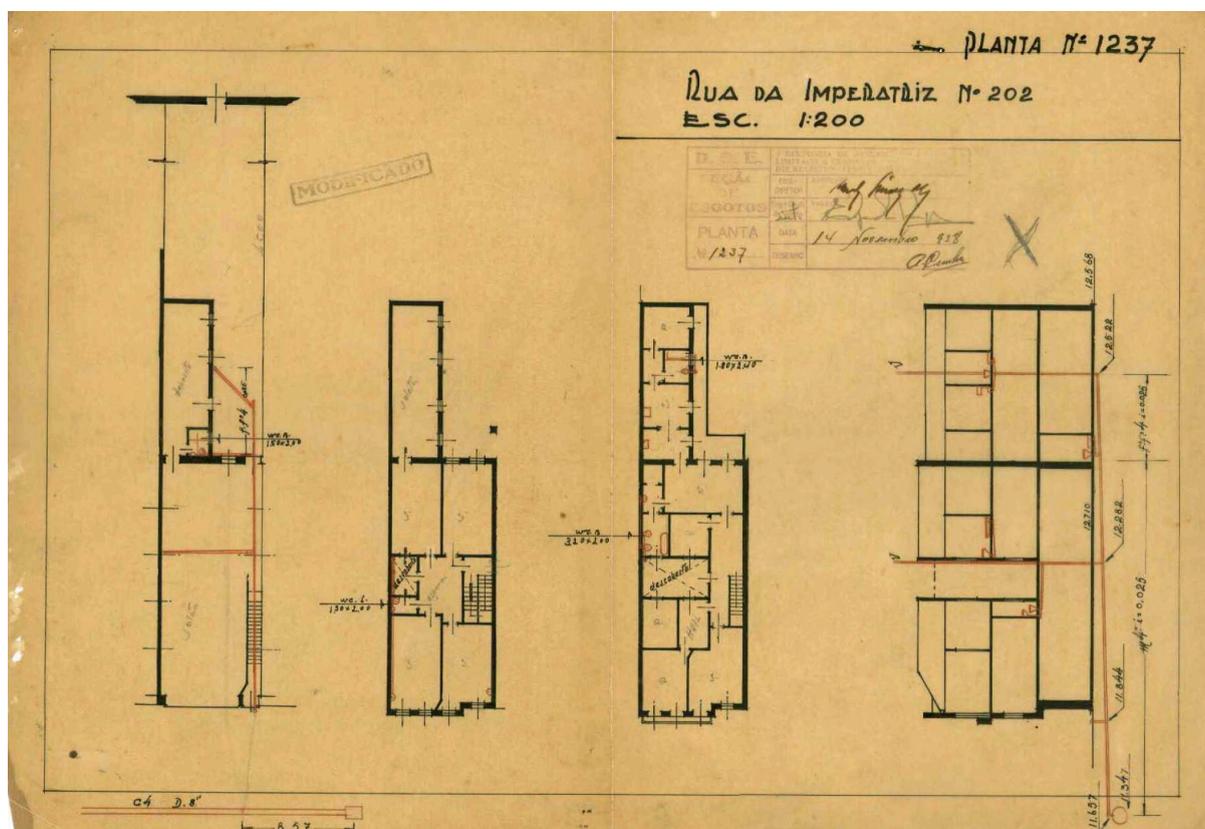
Da esquerda para direita: plantas baixas do térreo, primeiro e segundo pavimentos, e planta de instalações hidráulicas. Acervo de Saturnino de Brito.
